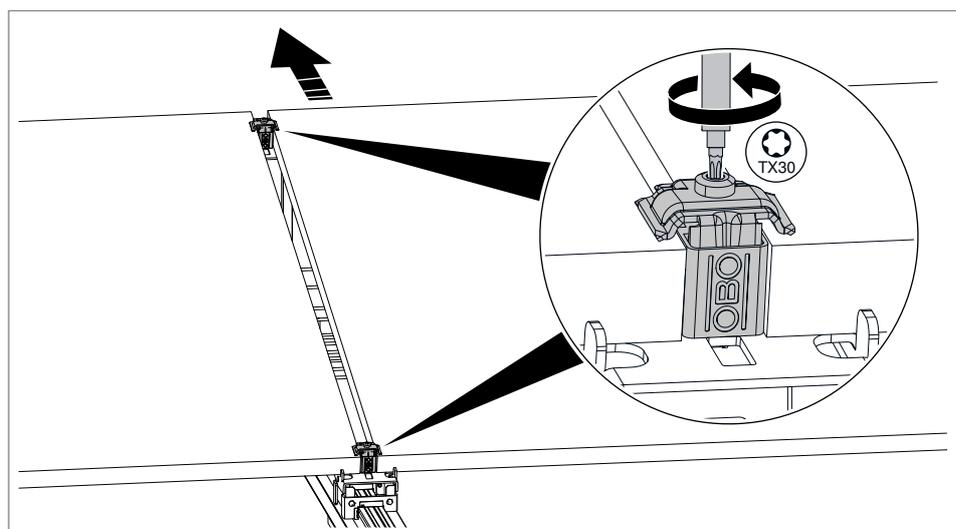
PV-Modul auswechseln, Befestigung seitlich und mittig
